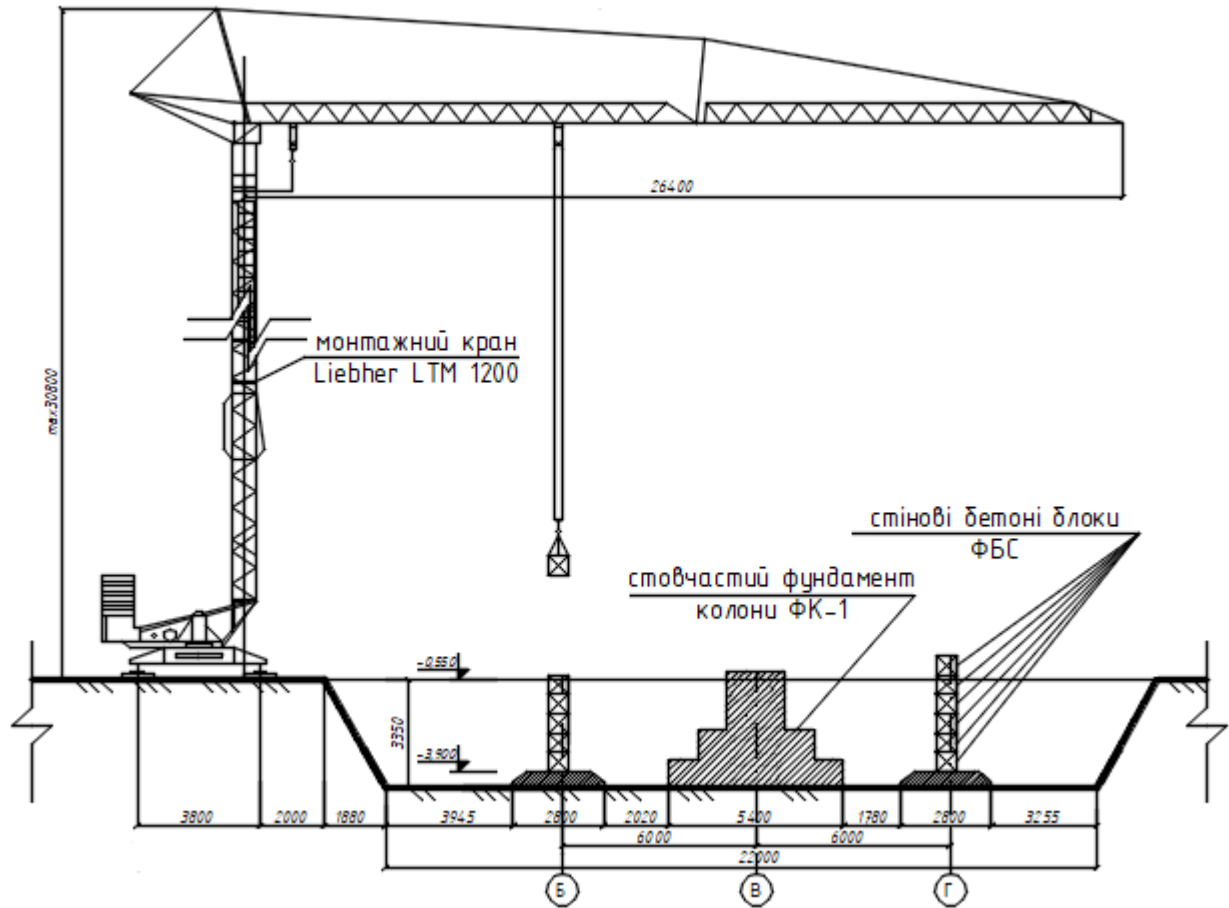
Монтажна схема до вибору монтажного крану.
